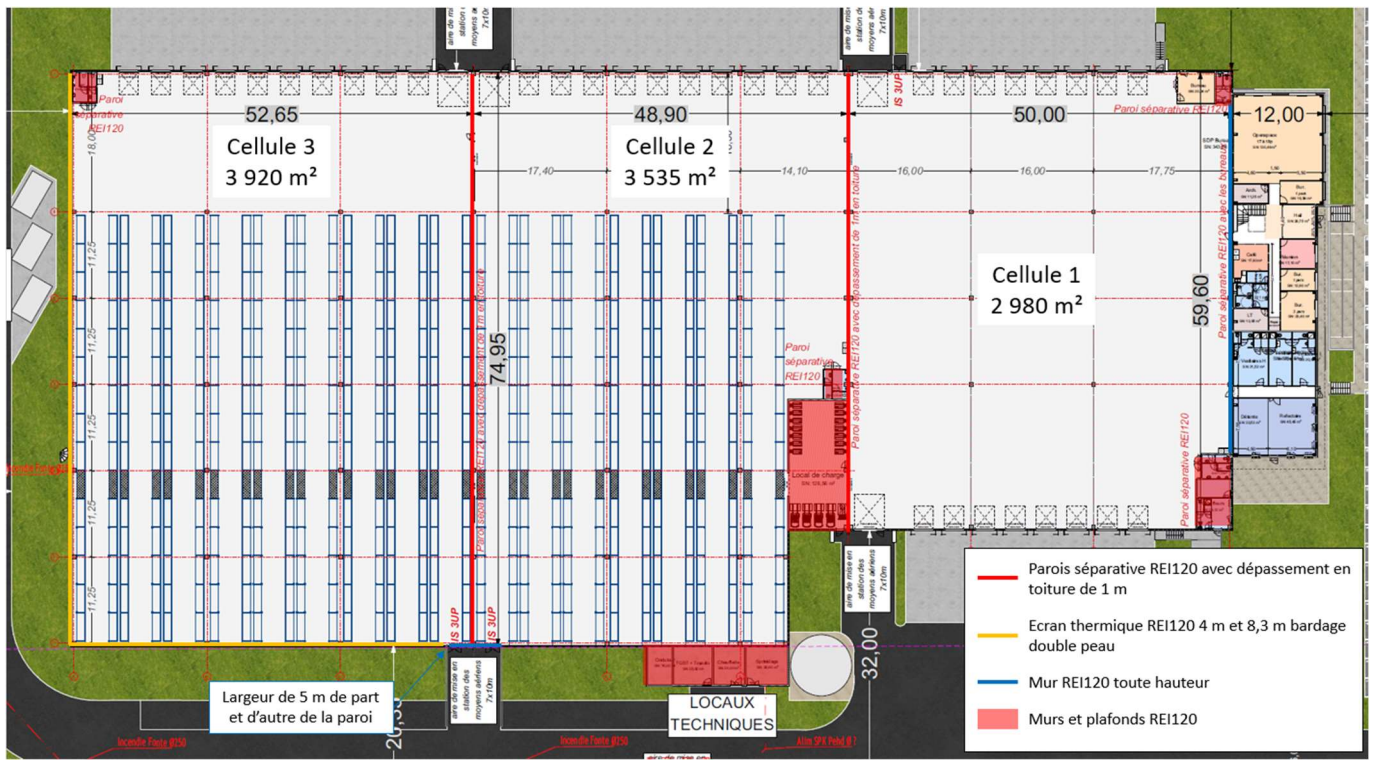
Plan des murs coupe-feu (source : dossier de demande d'enregistrement)
